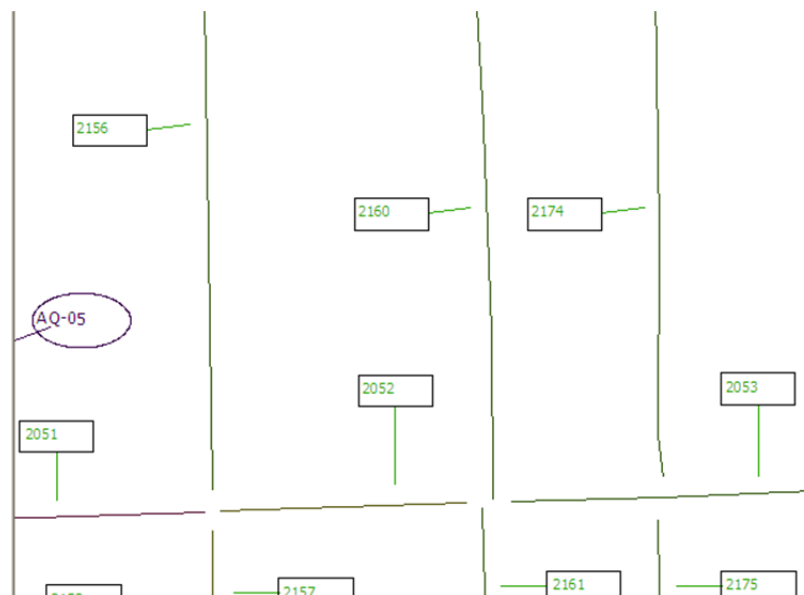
Exemple du fichier AutoCAD du plan d'intervention.
